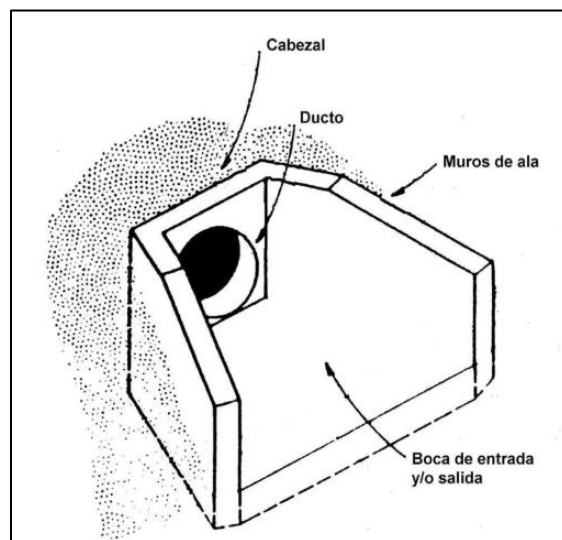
Principales elementos que constituyen una alcantarilla.
